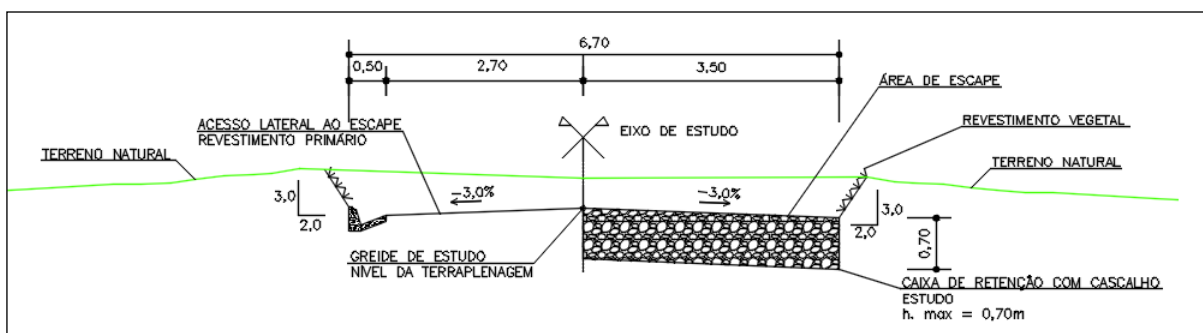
Rampa de Escape – Seção Transversal Tipo em Corte.
